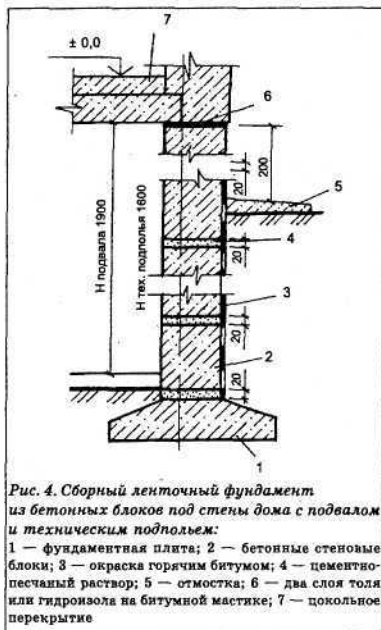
Сборный ленточный фундамент из бетонных блоков под стены дома с подвалом и техническим подпольем:
